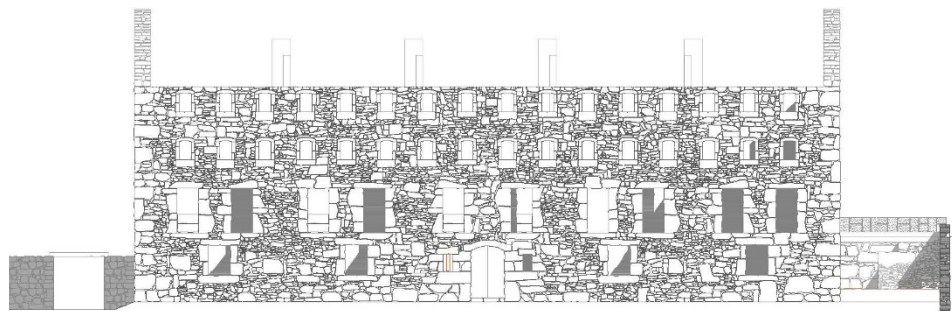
Levantamiento. Estado actual. Alzado Sur fábrica
